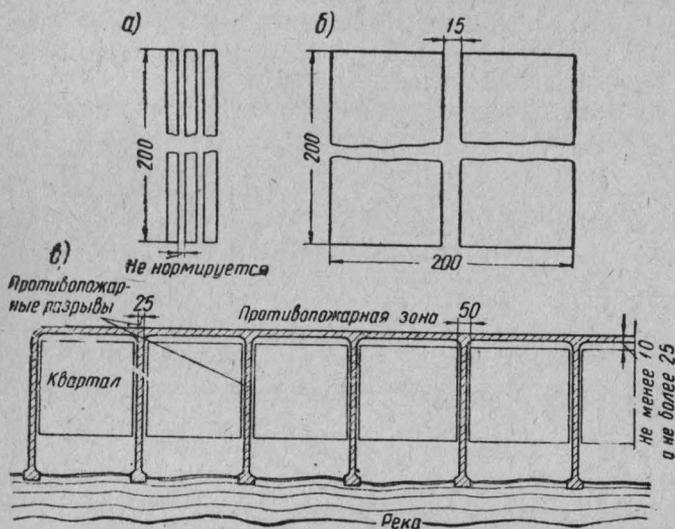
Склады круглого леса при хранении бревен в весенне-летний период года:
